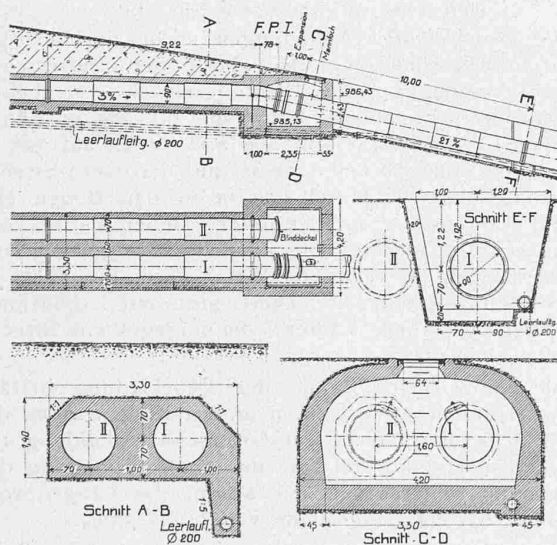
Fixpunkt I. — Masstab für Längsschnitte und Grundrisse 1:300, für die Querschnitte 1:120.
